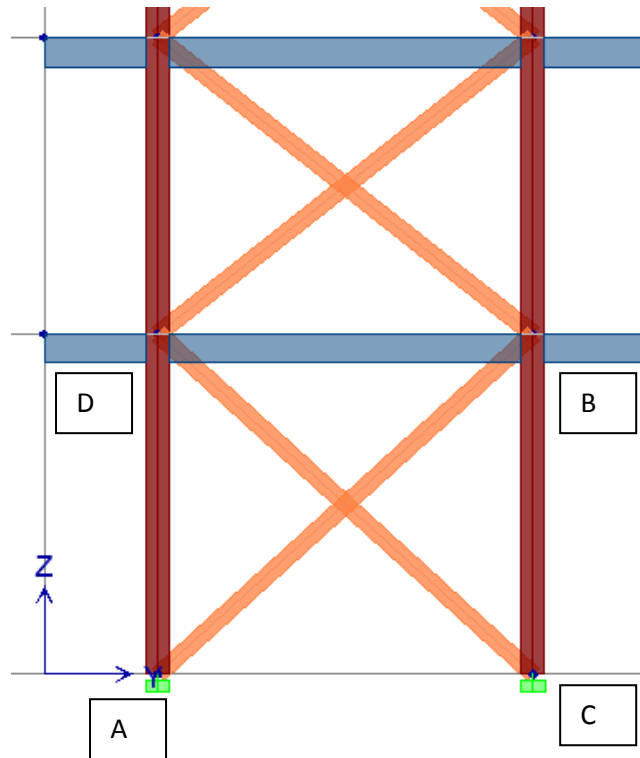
Vista de Pórticos con Arriostres sin Columnas Zipper
